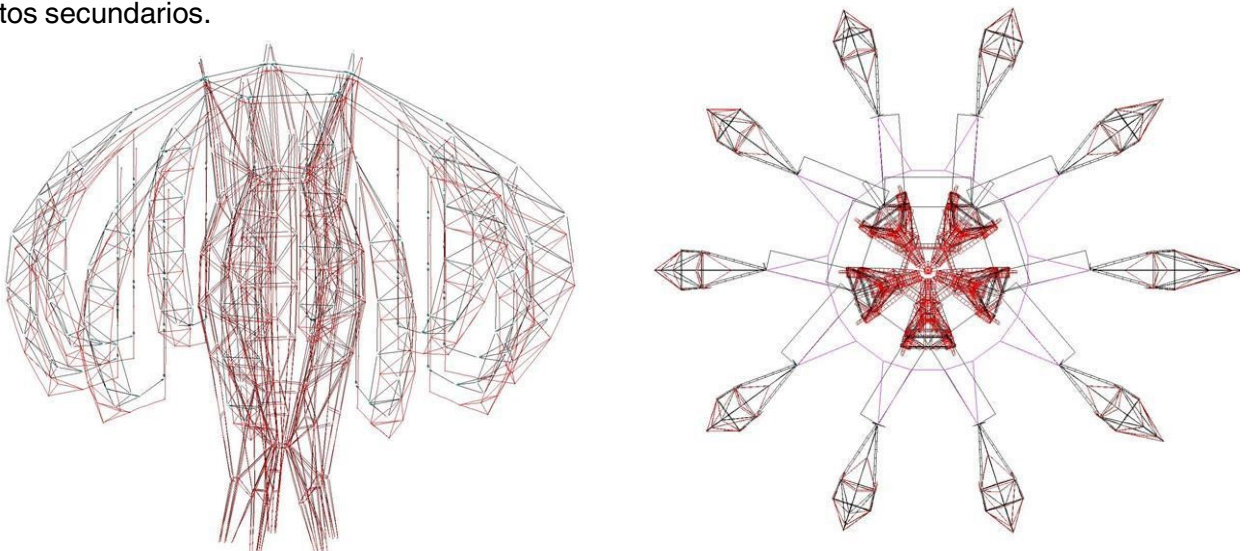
Modelos informáticos de la subestructura soporte de la fachada textil de la sede de Iguzzini.
